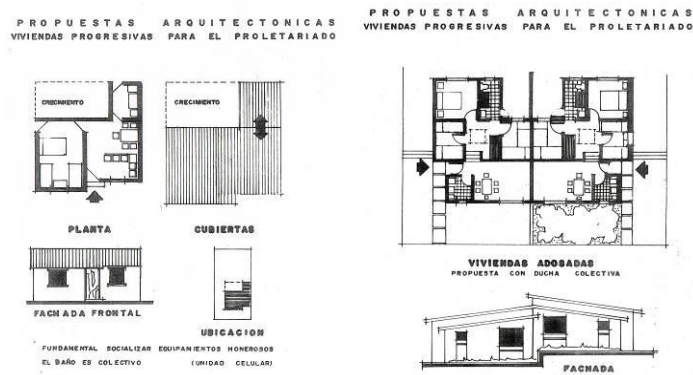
Planimetrías de dos de los prototipos de vivienda. (Fuente: “Hacia un urbanismo popular”, 1976)
